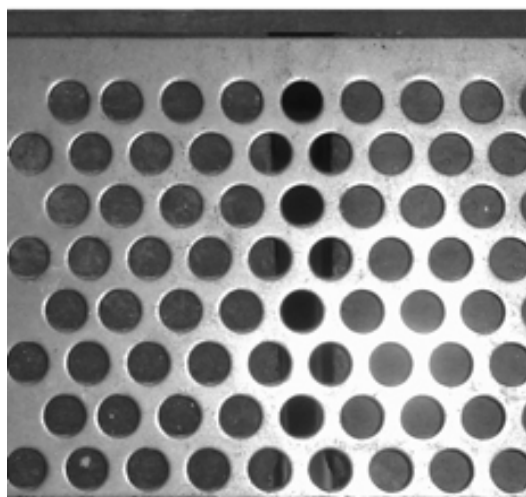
21: detalhe da fixação dos painéis de parede com chapa metálica perfurada.
